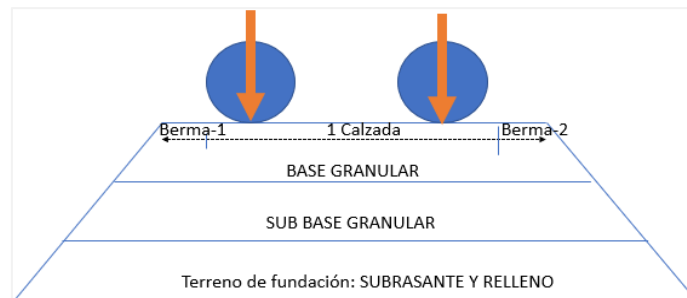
Capas típicas de pavimento flexible. Fuente propia.
